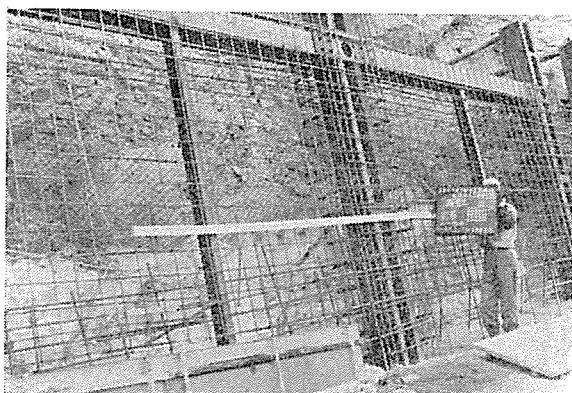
コンクリートのり覆工、鋼材(形鋼、鉄筋)組立
